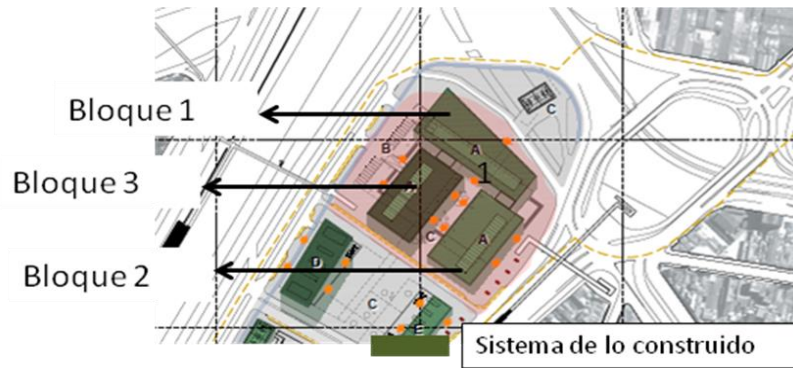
Elementos del sistema construido en La Plaza Minorista
